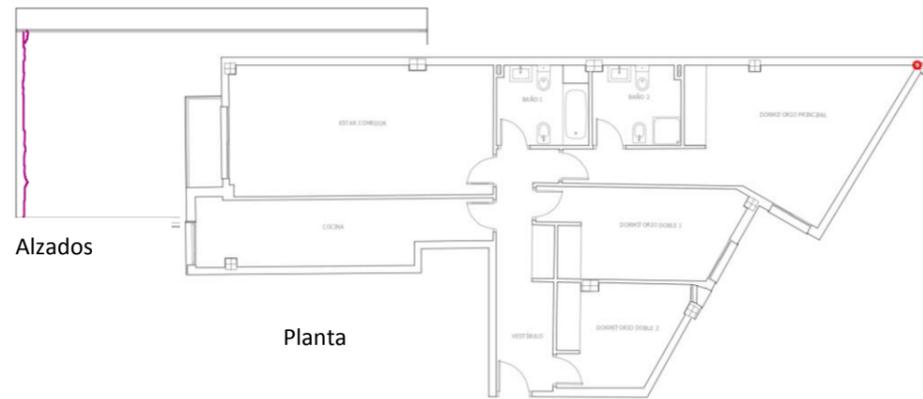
Fisura grandes/ grietas vivienda 7 planta segunda. 2018. Elaboración propia
